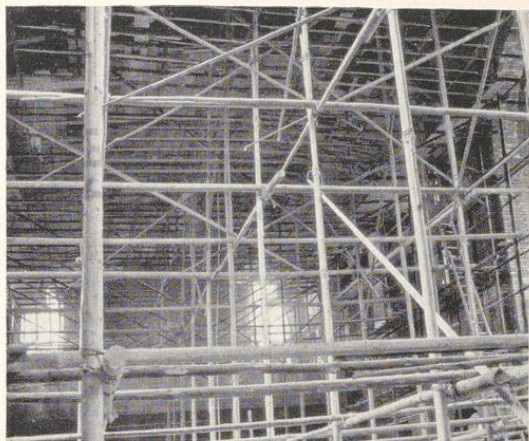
Innenrüstung mit Quer-, Streich- und Sattelstangen
